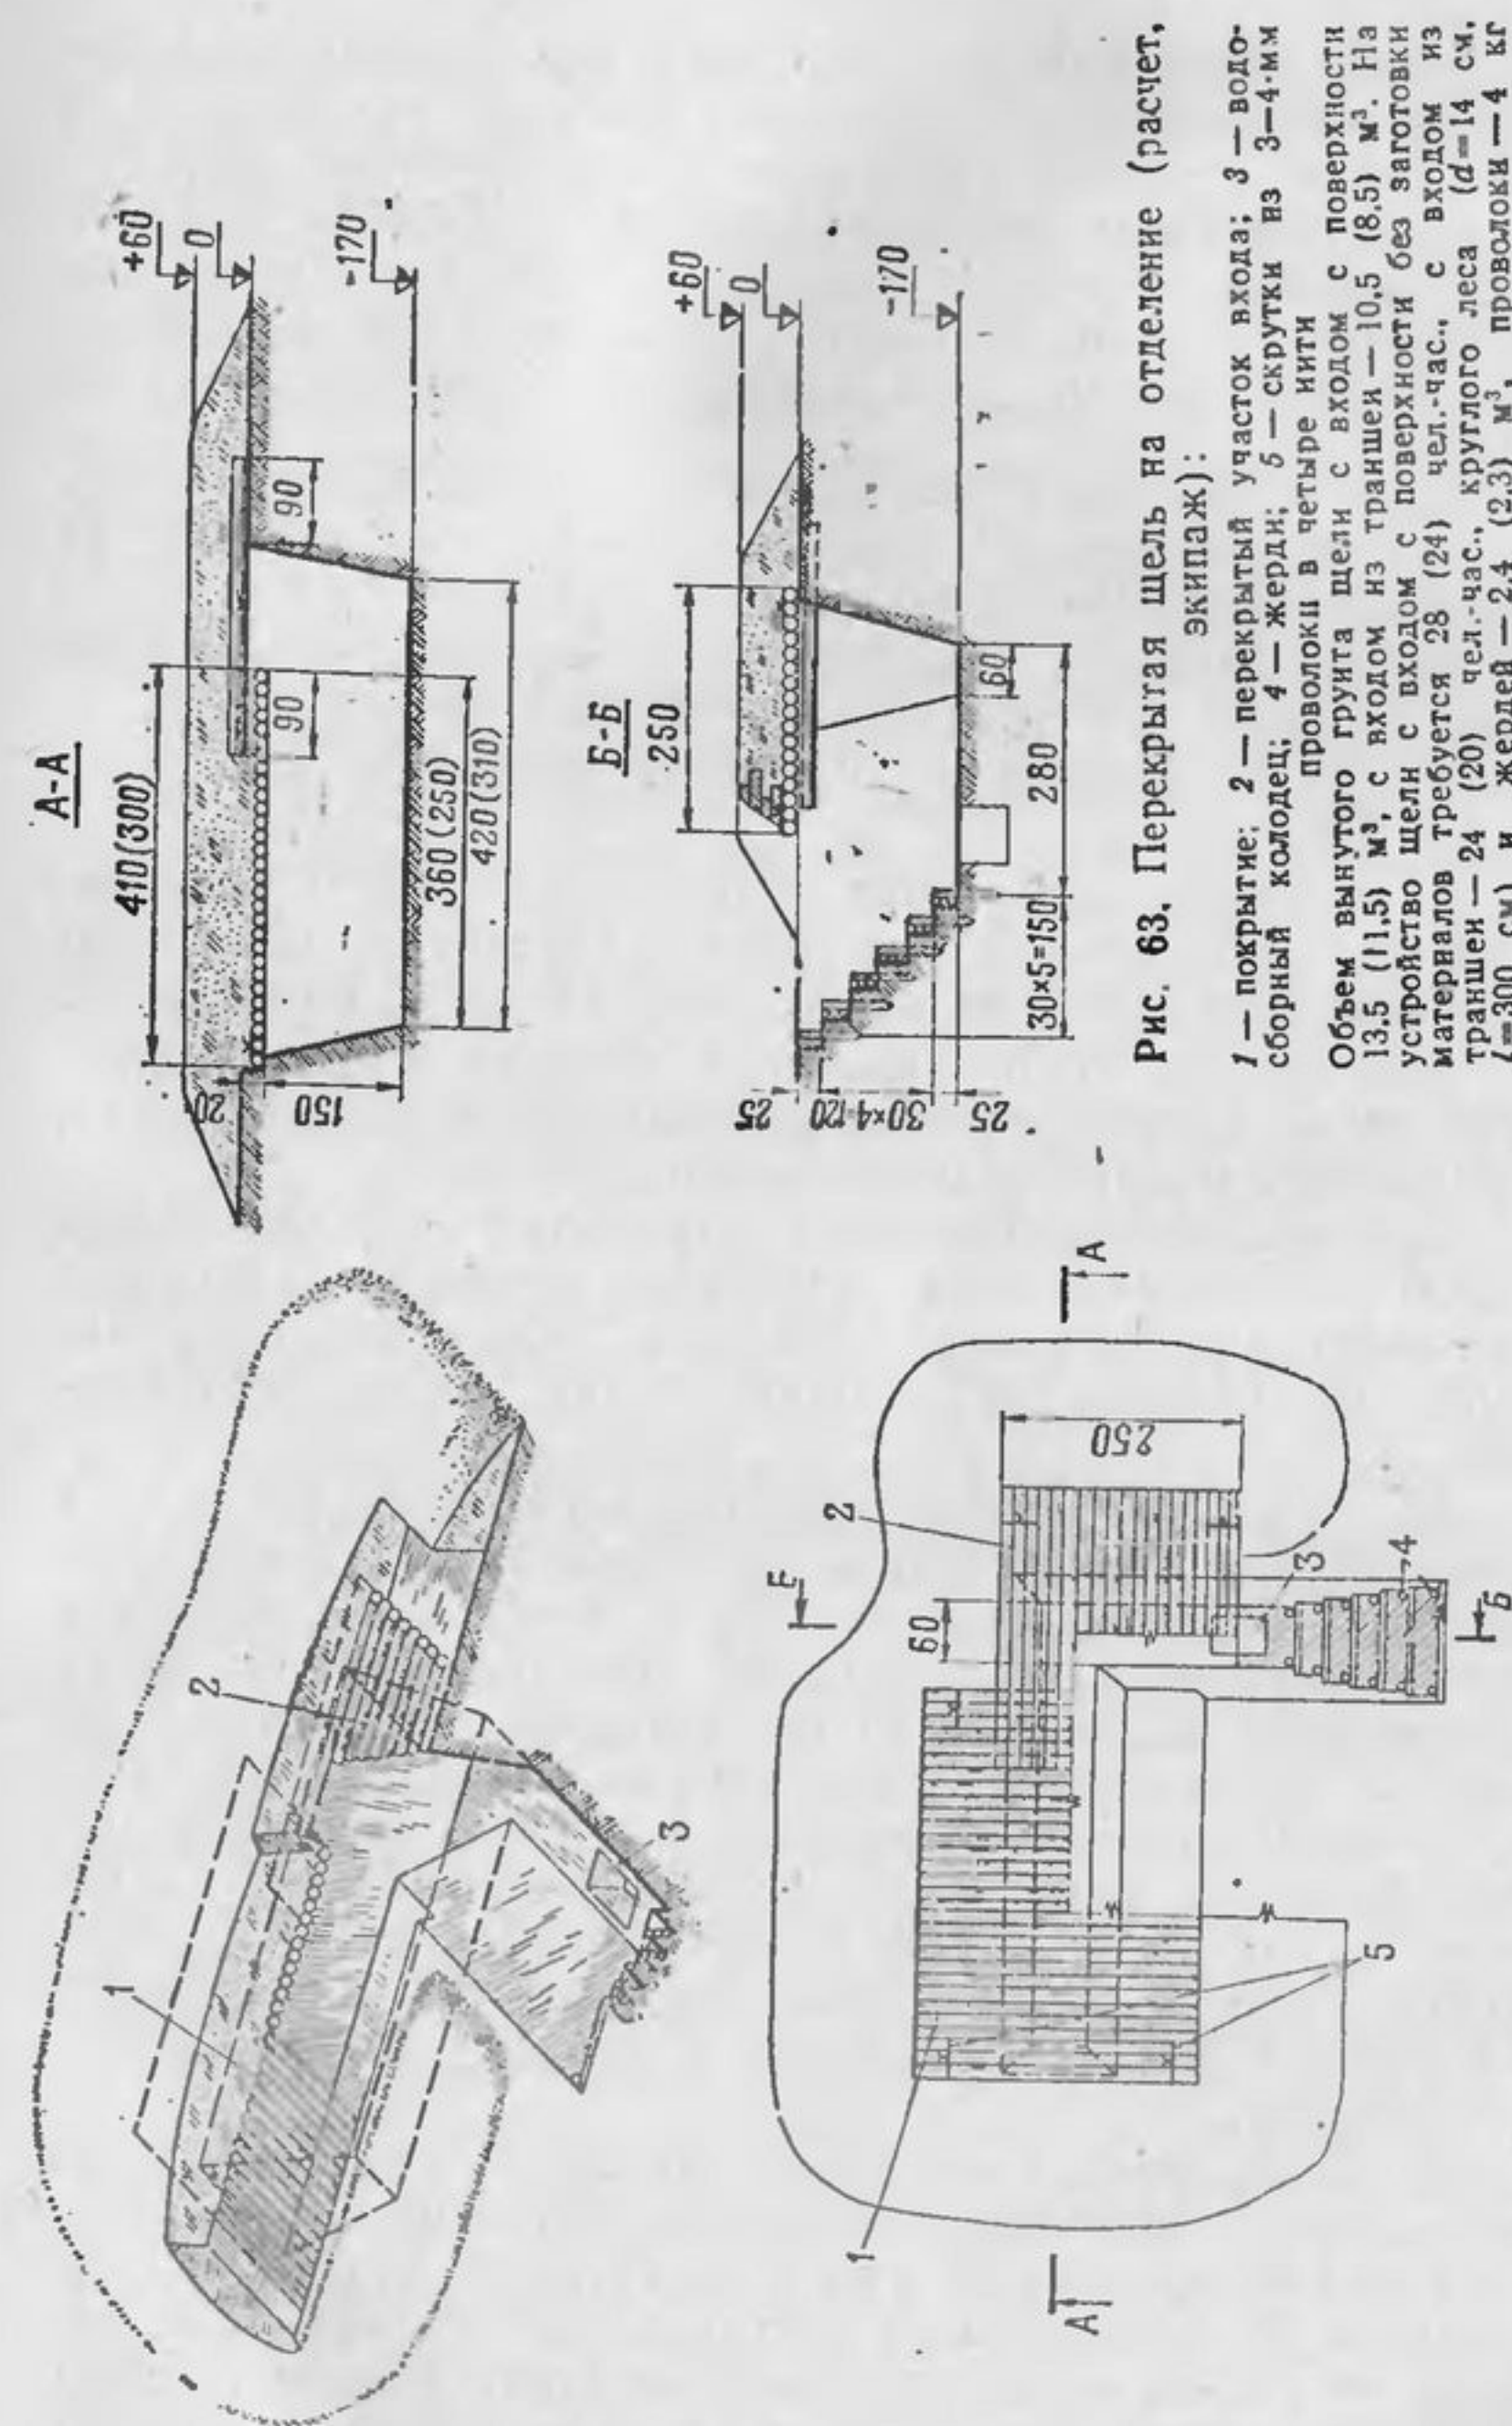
Перекрытая щель на отделение (расчет, экипаж):
